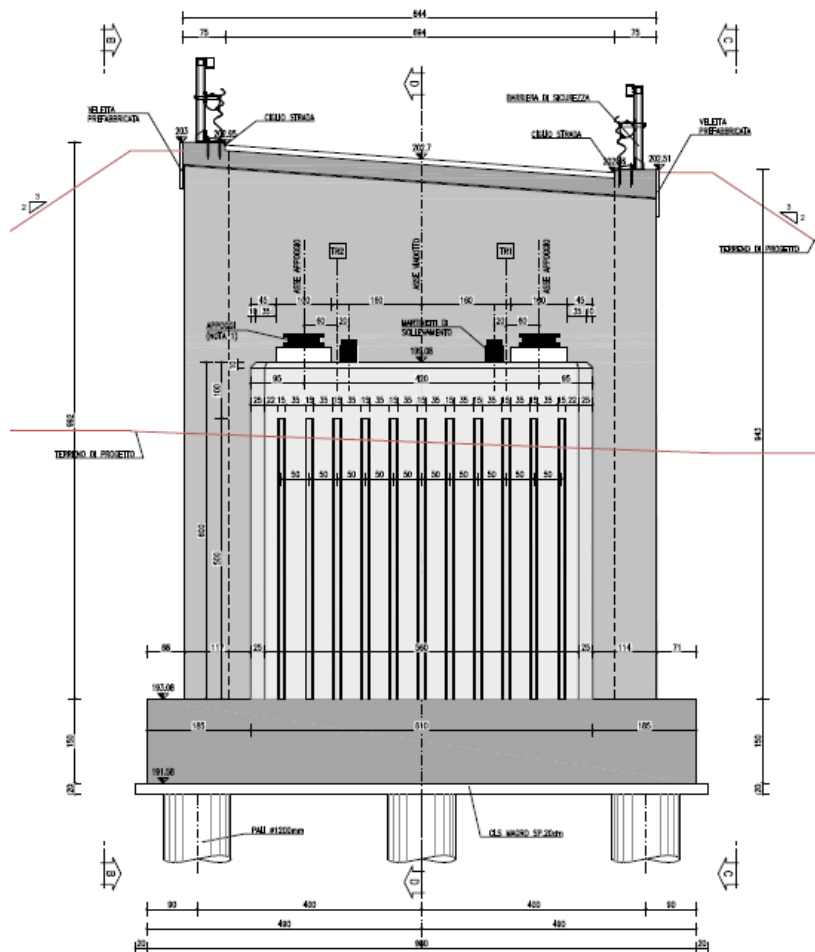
Spalla 2 – carpenteria elevazioni
